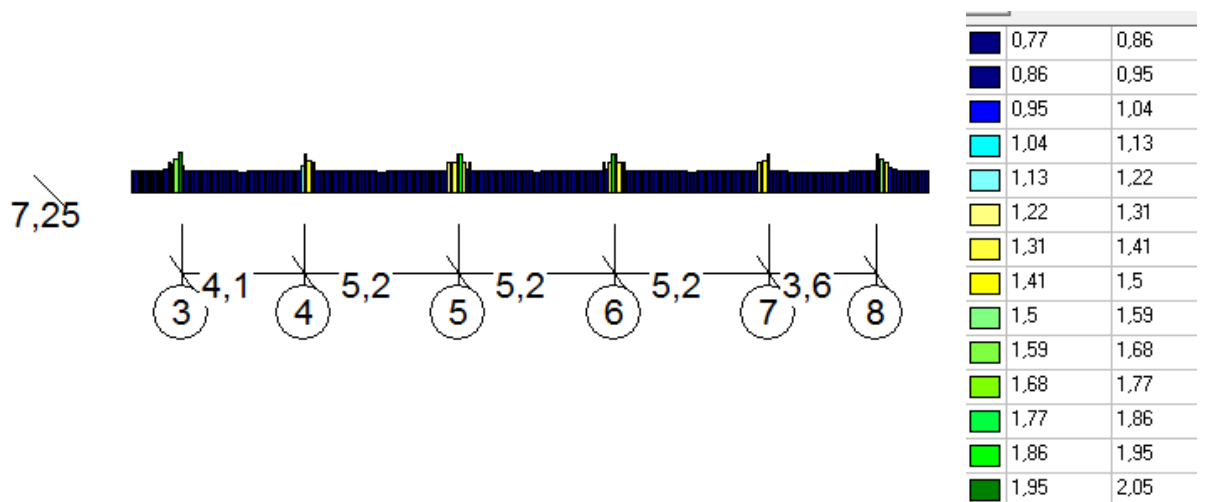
Эпюра верхней арматуры второстепенной балки
